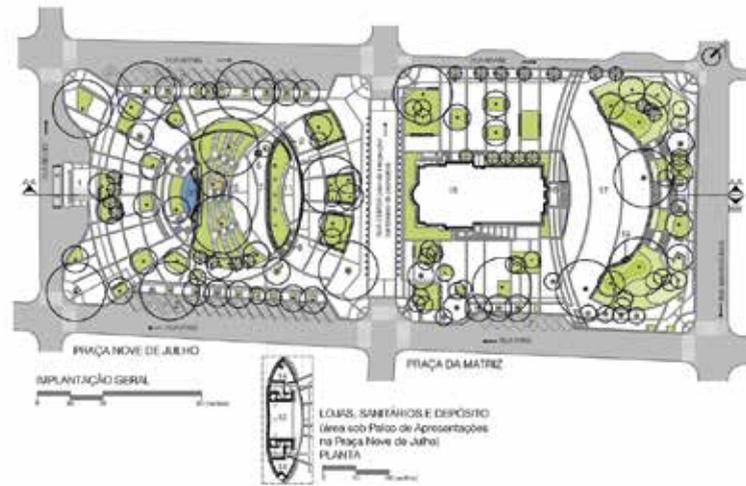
Planta baixa das praças 9 de Julho e Matriz.
